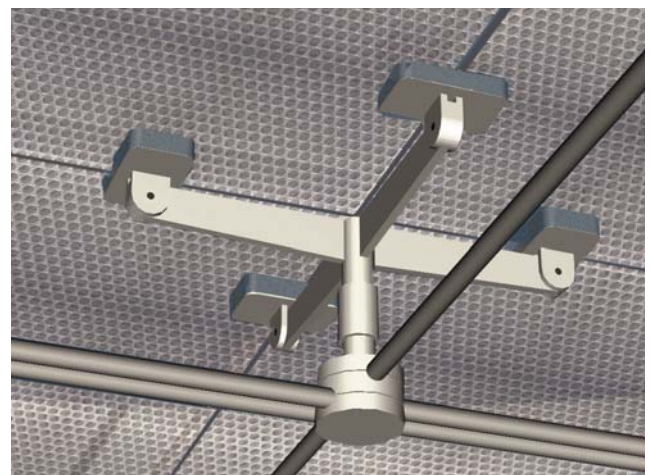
Detail-Studie zu einer unterspannten Dachkonstruktion, 3D-Wabenplatten mit Glas-/Glas+PC-Deckschichten
